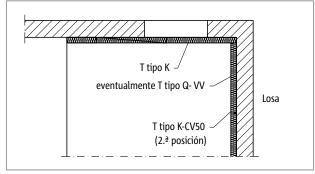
Schöck Isokorb® T tipo K, Q- VV: Balcón en esquina interna, apoyado sobre dos laterales
